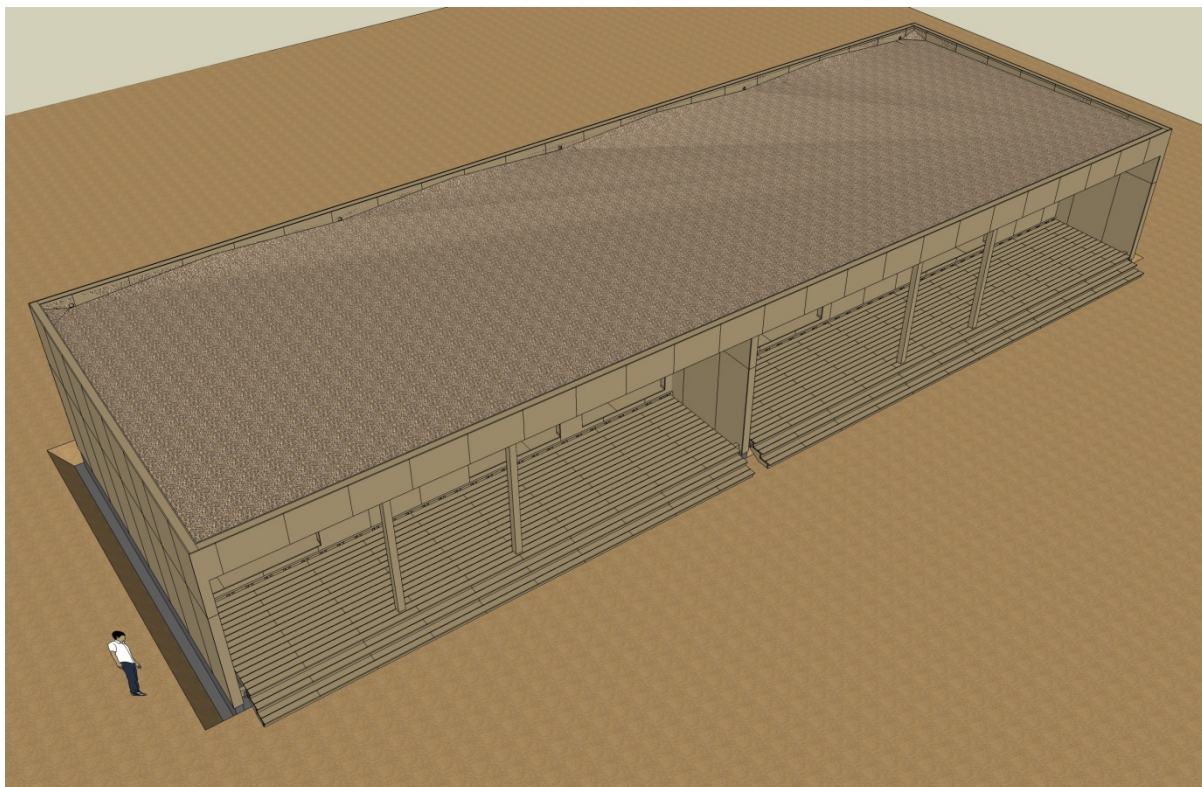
Montagem do isolamento e impermeabilização de cobertura.
